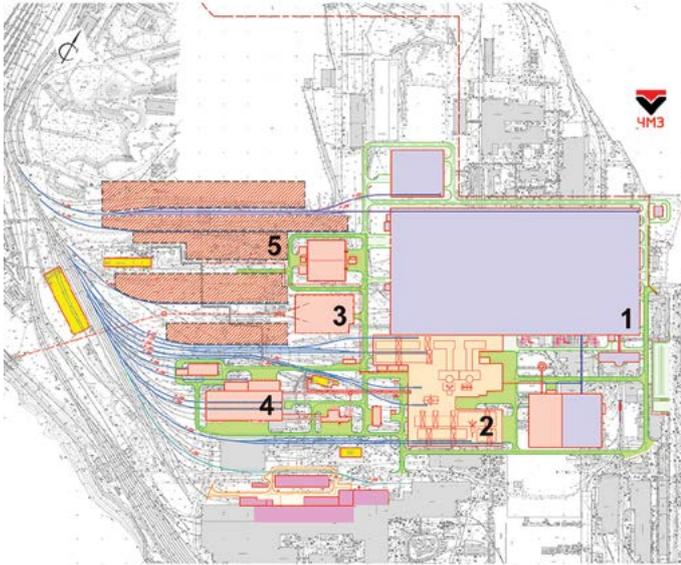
Генплан, пл. 1: 1 - Трубопрокатный цех; 2 - Электросталеплавильный цех с отделением подготовки лома; 3 - Электростанция; 4 - Участок подготовки материалов; 5 - Площадки резервного запаса лома; 6 - Реконструкция сортопрокатного цеха
